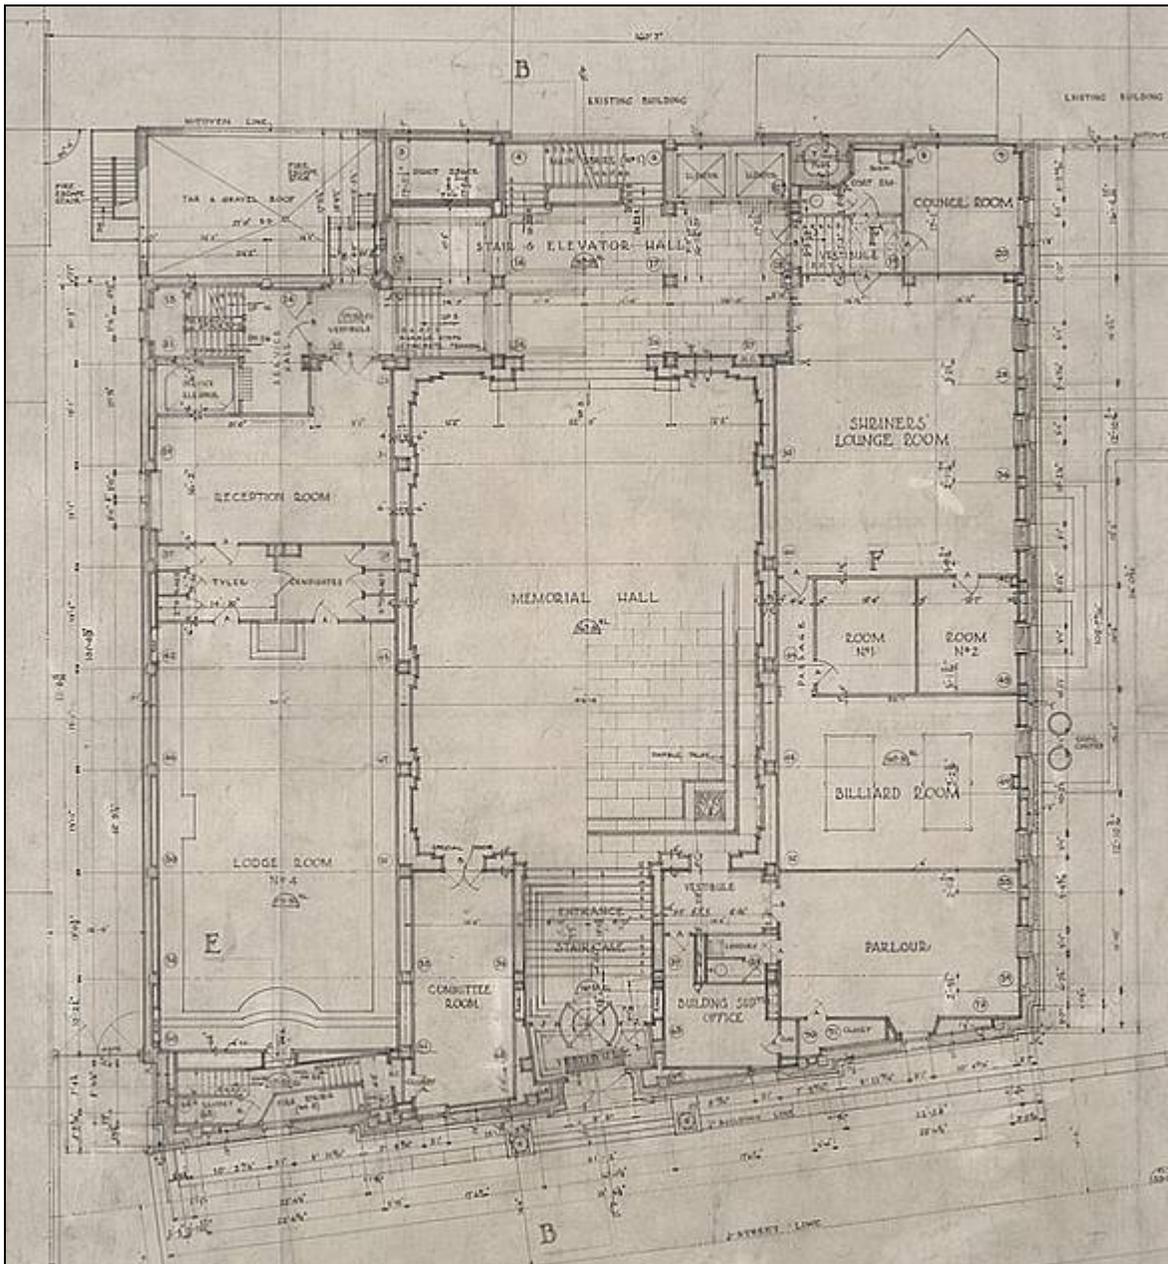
Plan du *ground floor*, ou étage n° 3 (détail de la feuille du plan).
